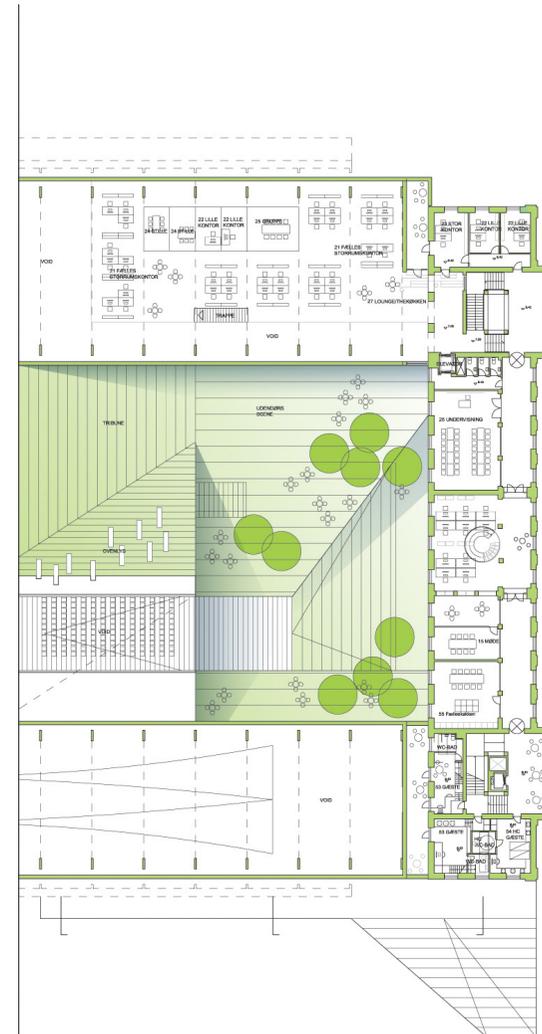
Railyards Kulturzentrum, Grundriss
